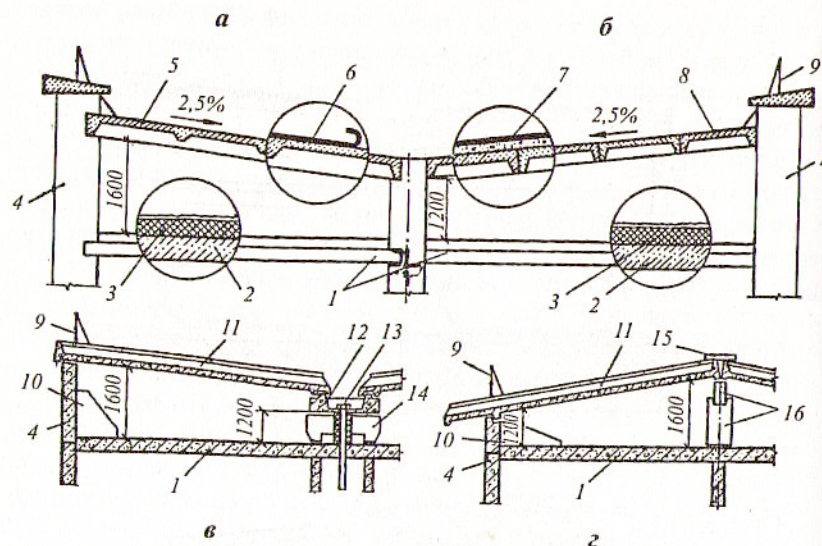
Конструктивные схемы железобетонных крыш с холодным чердаком:
